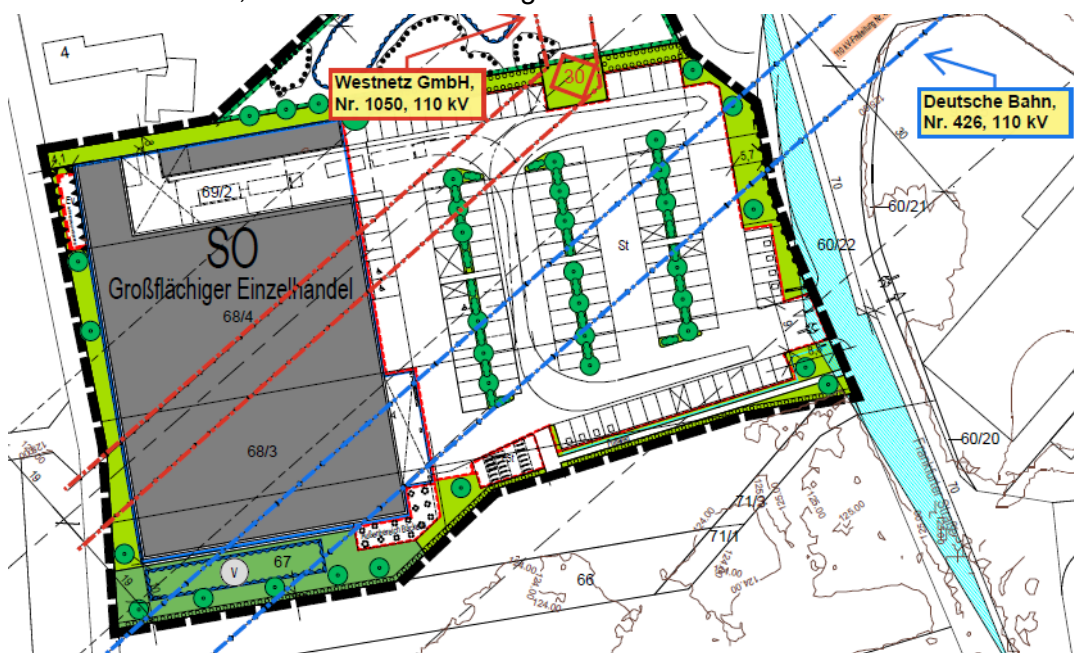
Lageplan der Baufläche für den geplanten Einzelhandel mit Trassen der 110-kV-Freileitungen (Westnetz GmbH: rot; DB: blau gestrichelt) und Mast 30 (rotes Rechteck).
